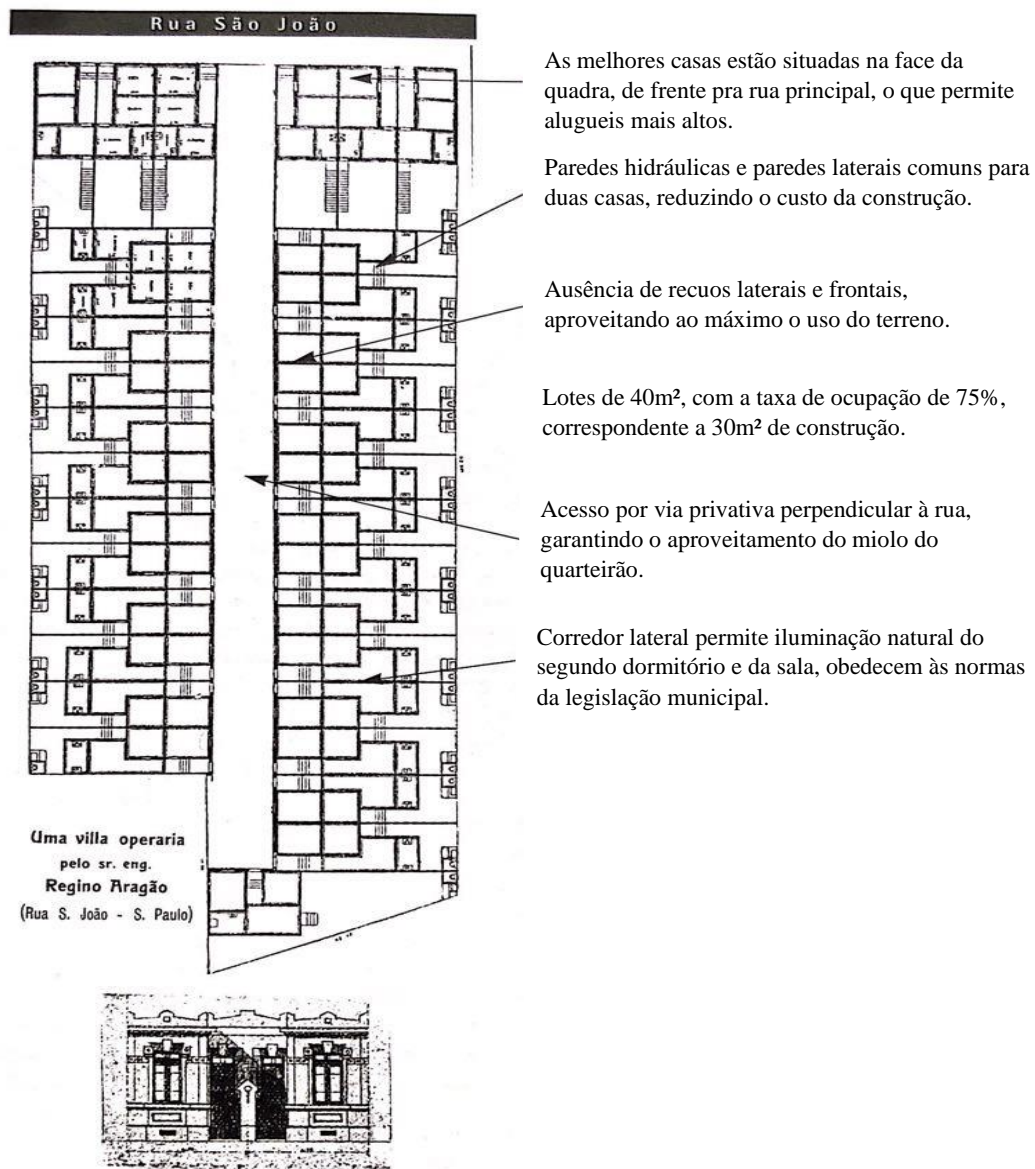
Planta baixa acima e fachada abaixo da Villa Operária projetada pelo engenheiro Regino Aragão.
